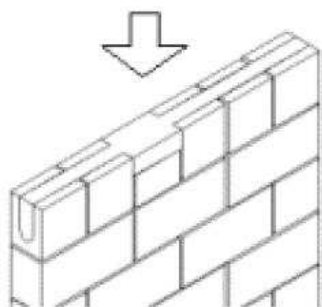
Muro de contenção em alvenaria estrutural protendida após aplicação da força de protensão
